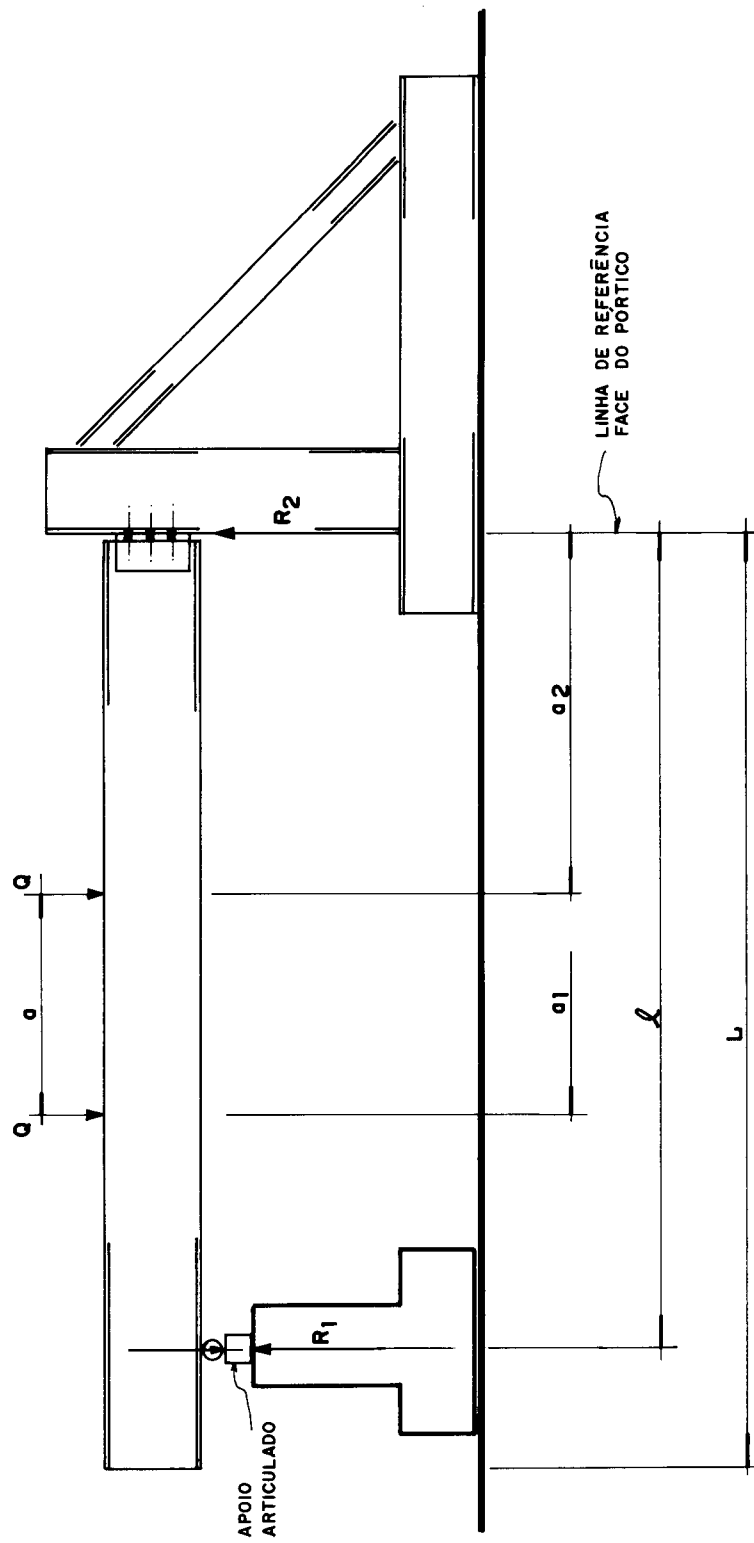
ESQUEMA DE ENSAIO - LIGAÇÃO TIPO C
